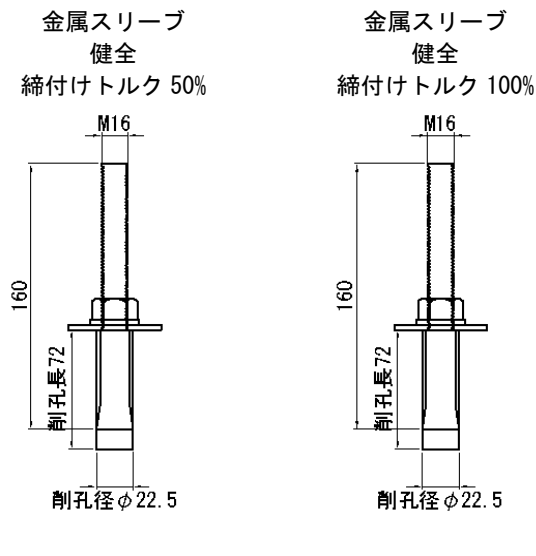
あと施工アンカー施工図（金属スリーブ軸力導入）
